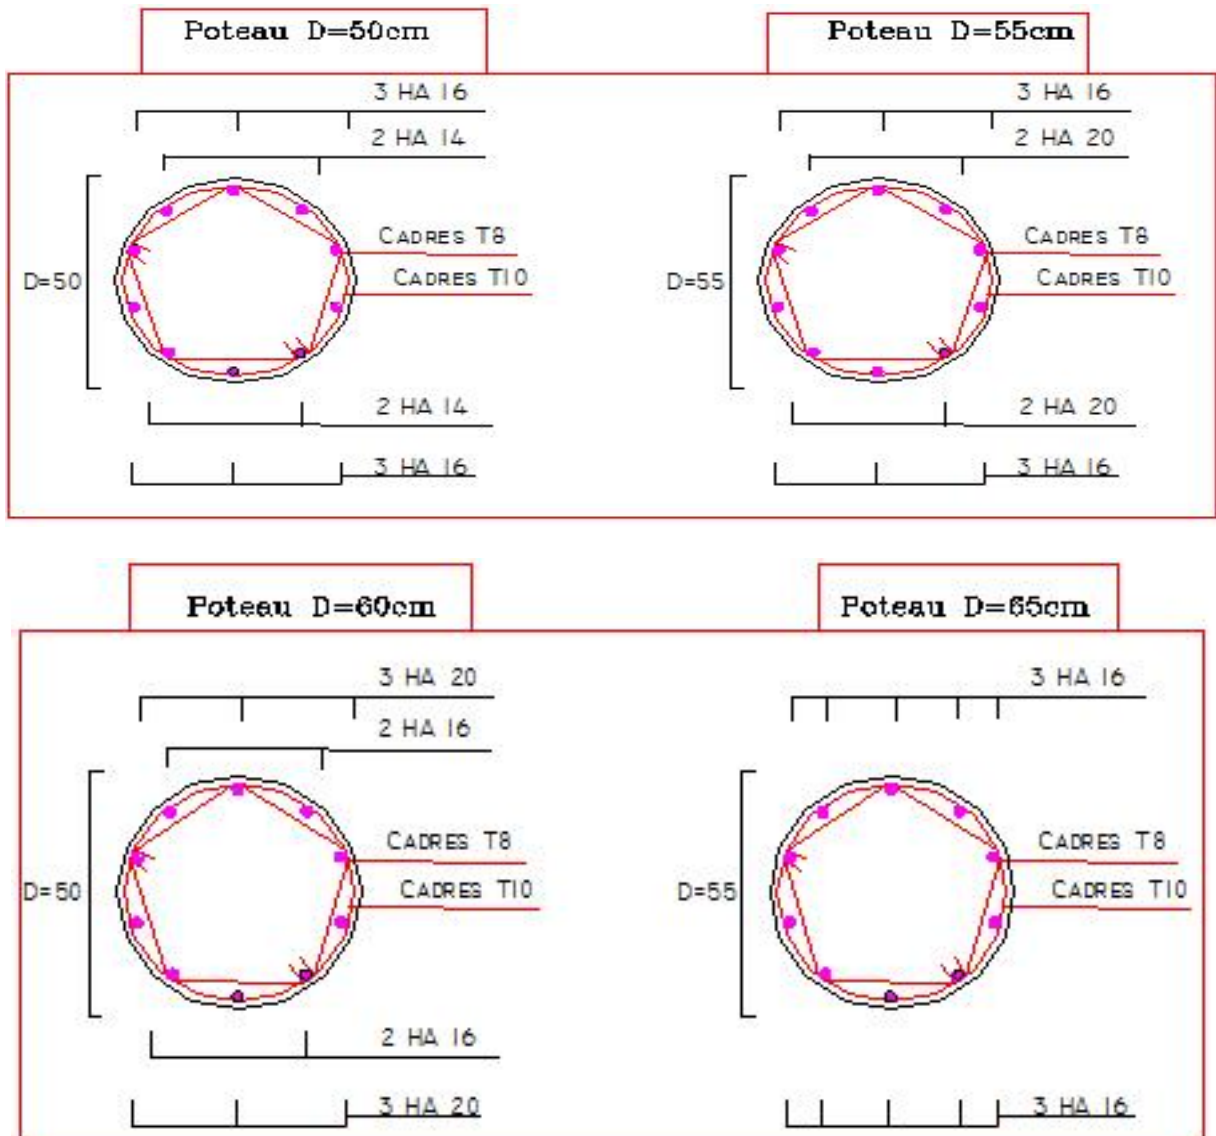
Schéma de ferrailage des Poteaux circulaires.
